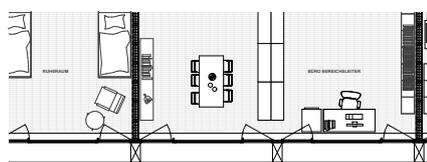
50 UNTERHALTSBETRIEBSGEBÄUDE
